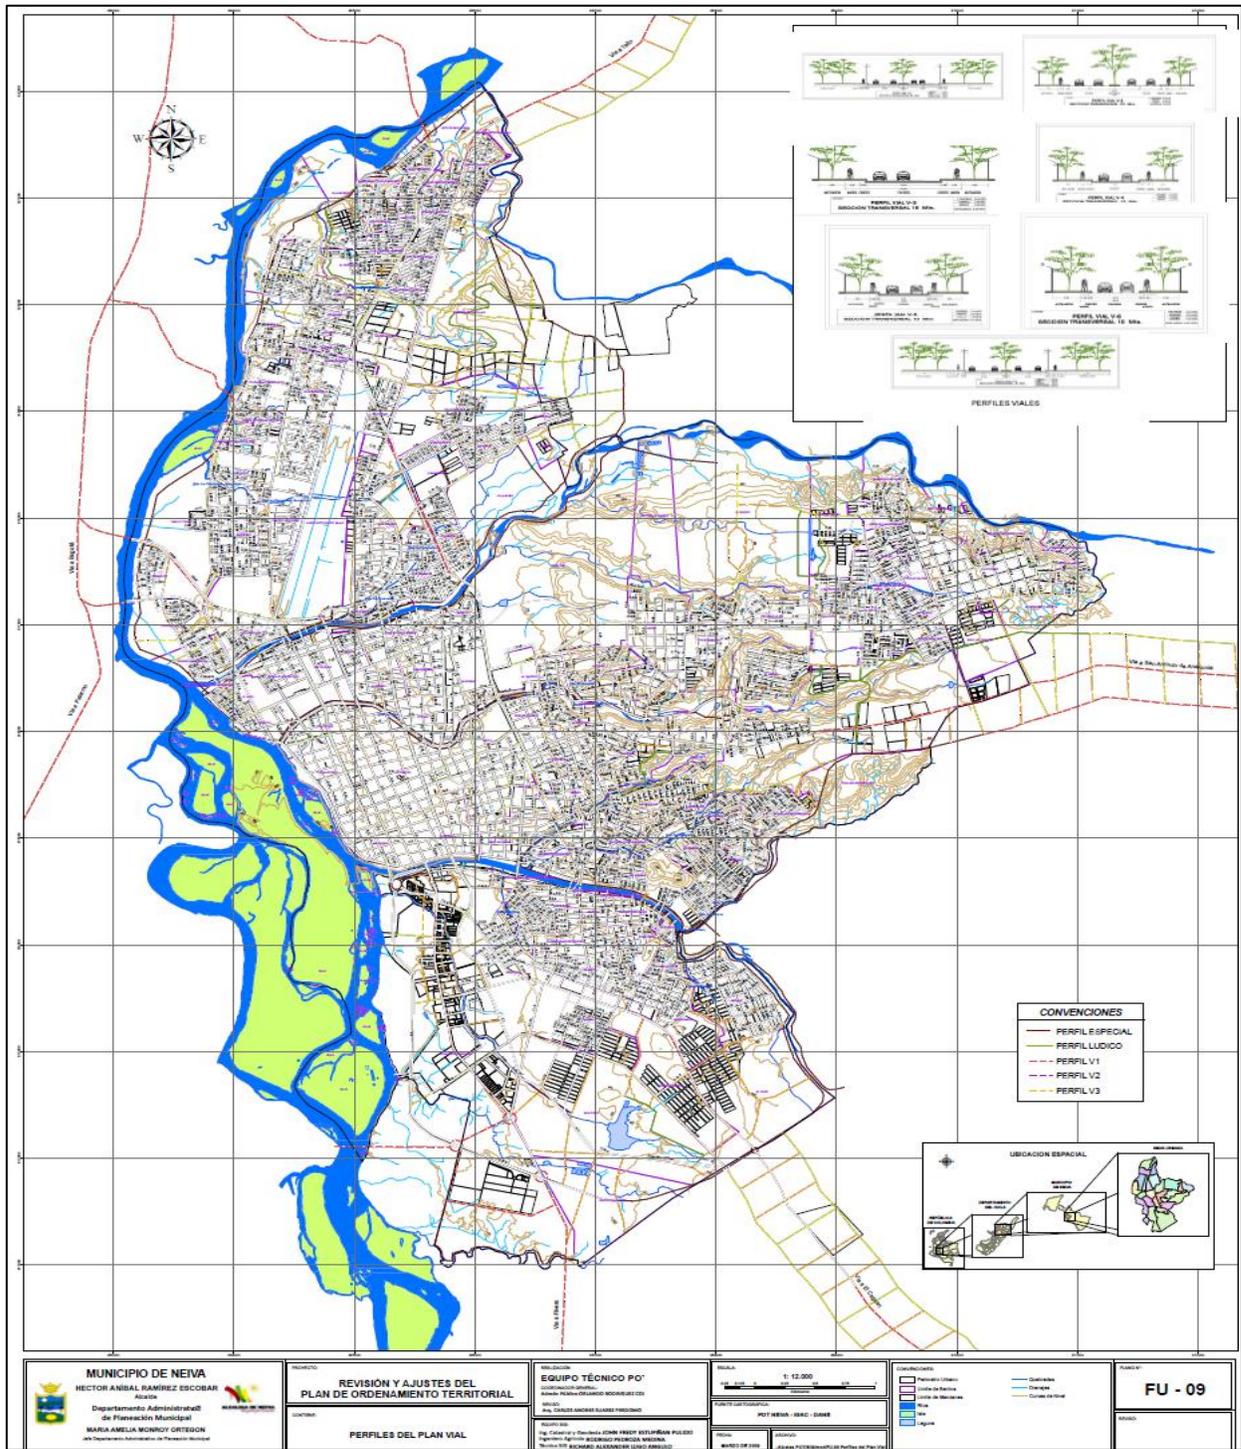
Plano de Perfiles del Plan vial Neiva. Fuente: Alcaldía Municipio de Neiva
